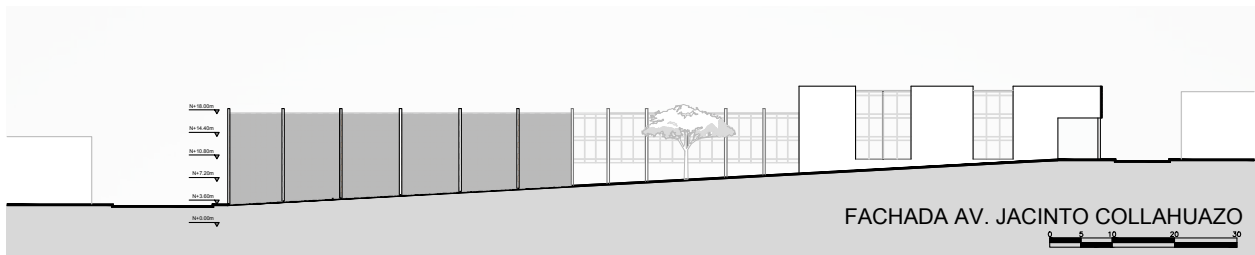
Fachada Av. Jacinto Collahuazo. Elaboración propia
